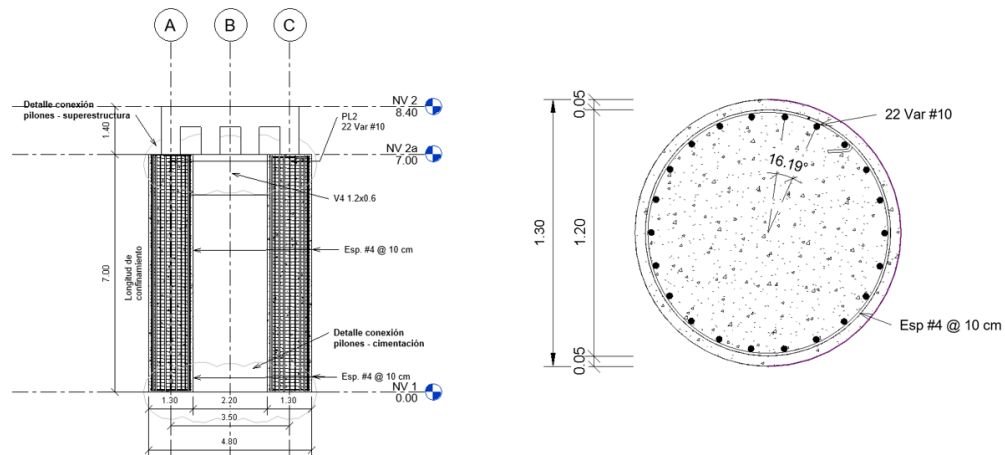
Generación de detalles de los pilones en los ejes 2 y 4
